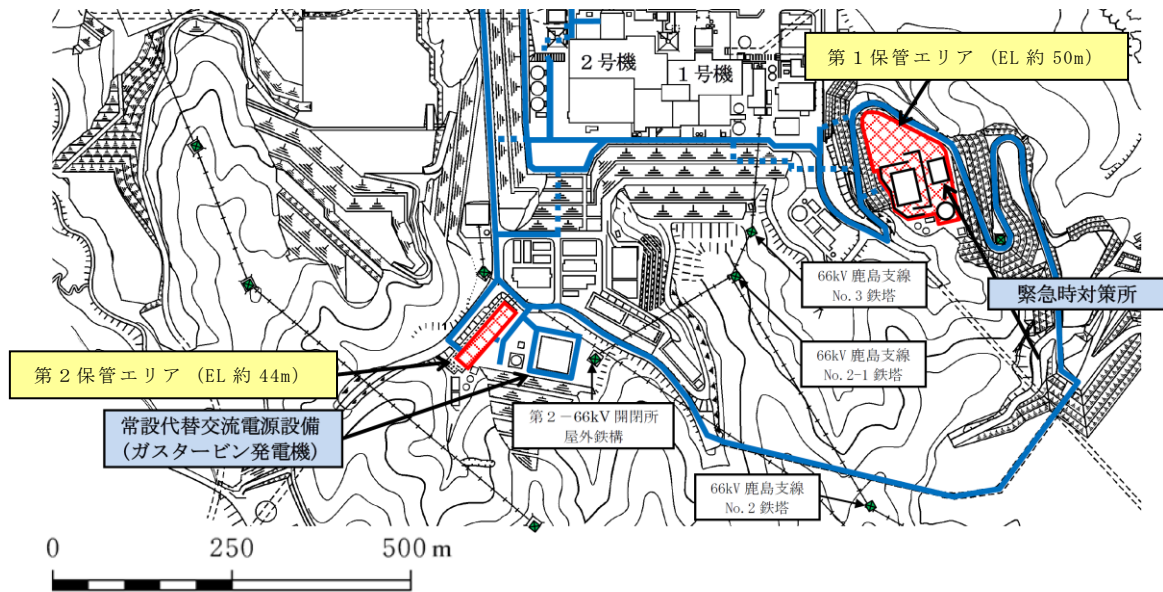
66kV 鹿島支線 No.2-1 鉄塔連成系モデル機器配置図
